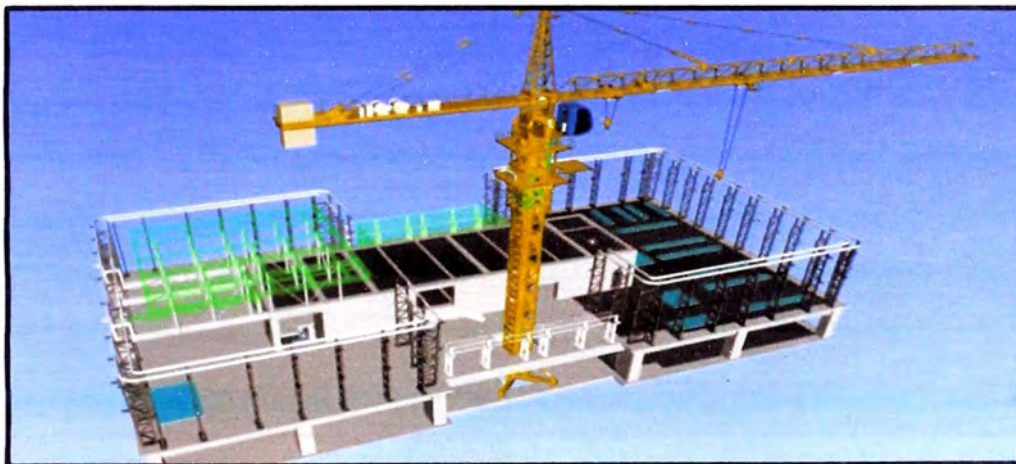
41: 4D de la Coronación del Edificio, Retiro de andamios y colocación de soporteria del muro cortina
